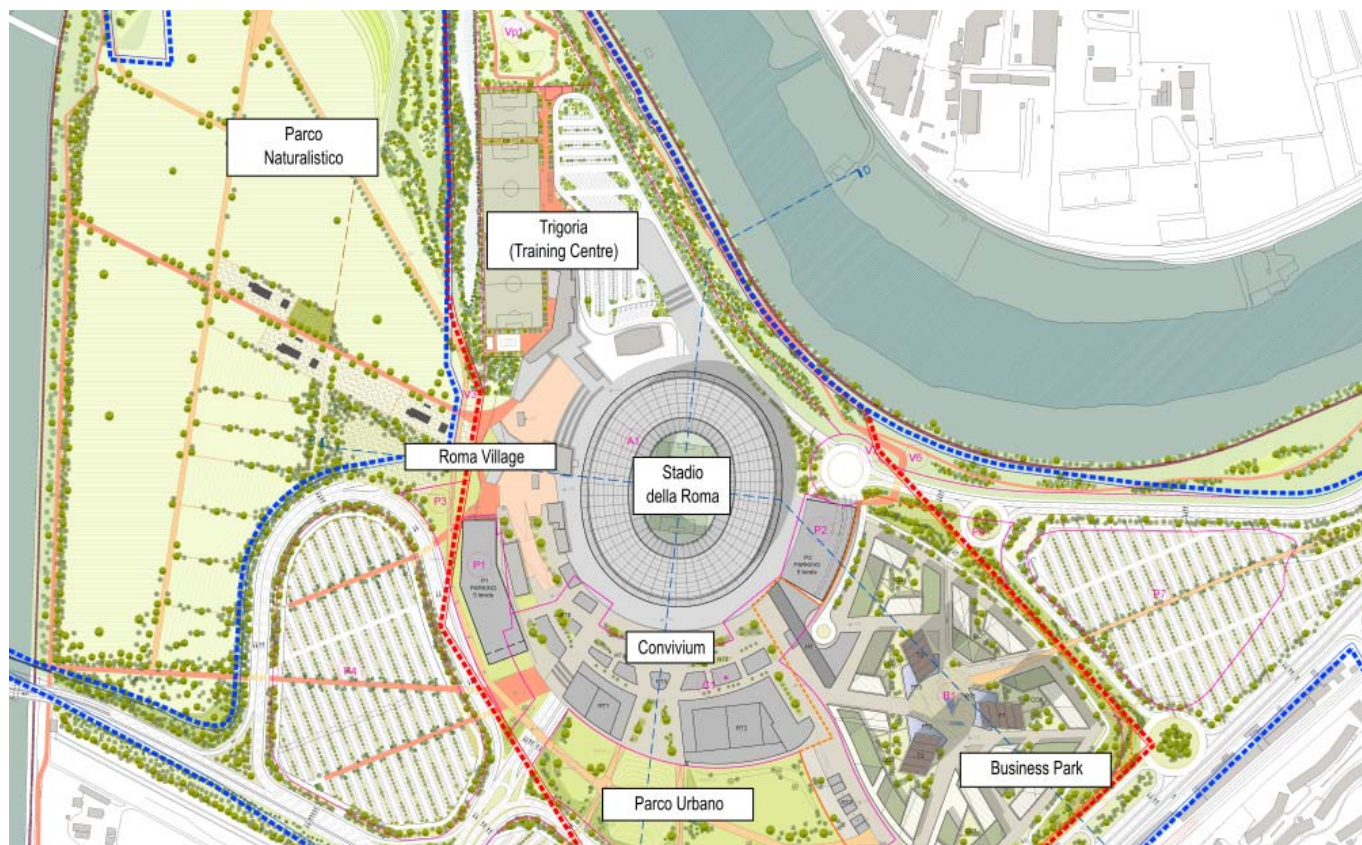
Planimetria dell'area Tor di Valle, Piano di Sviluppo 20 maggio 2015.
